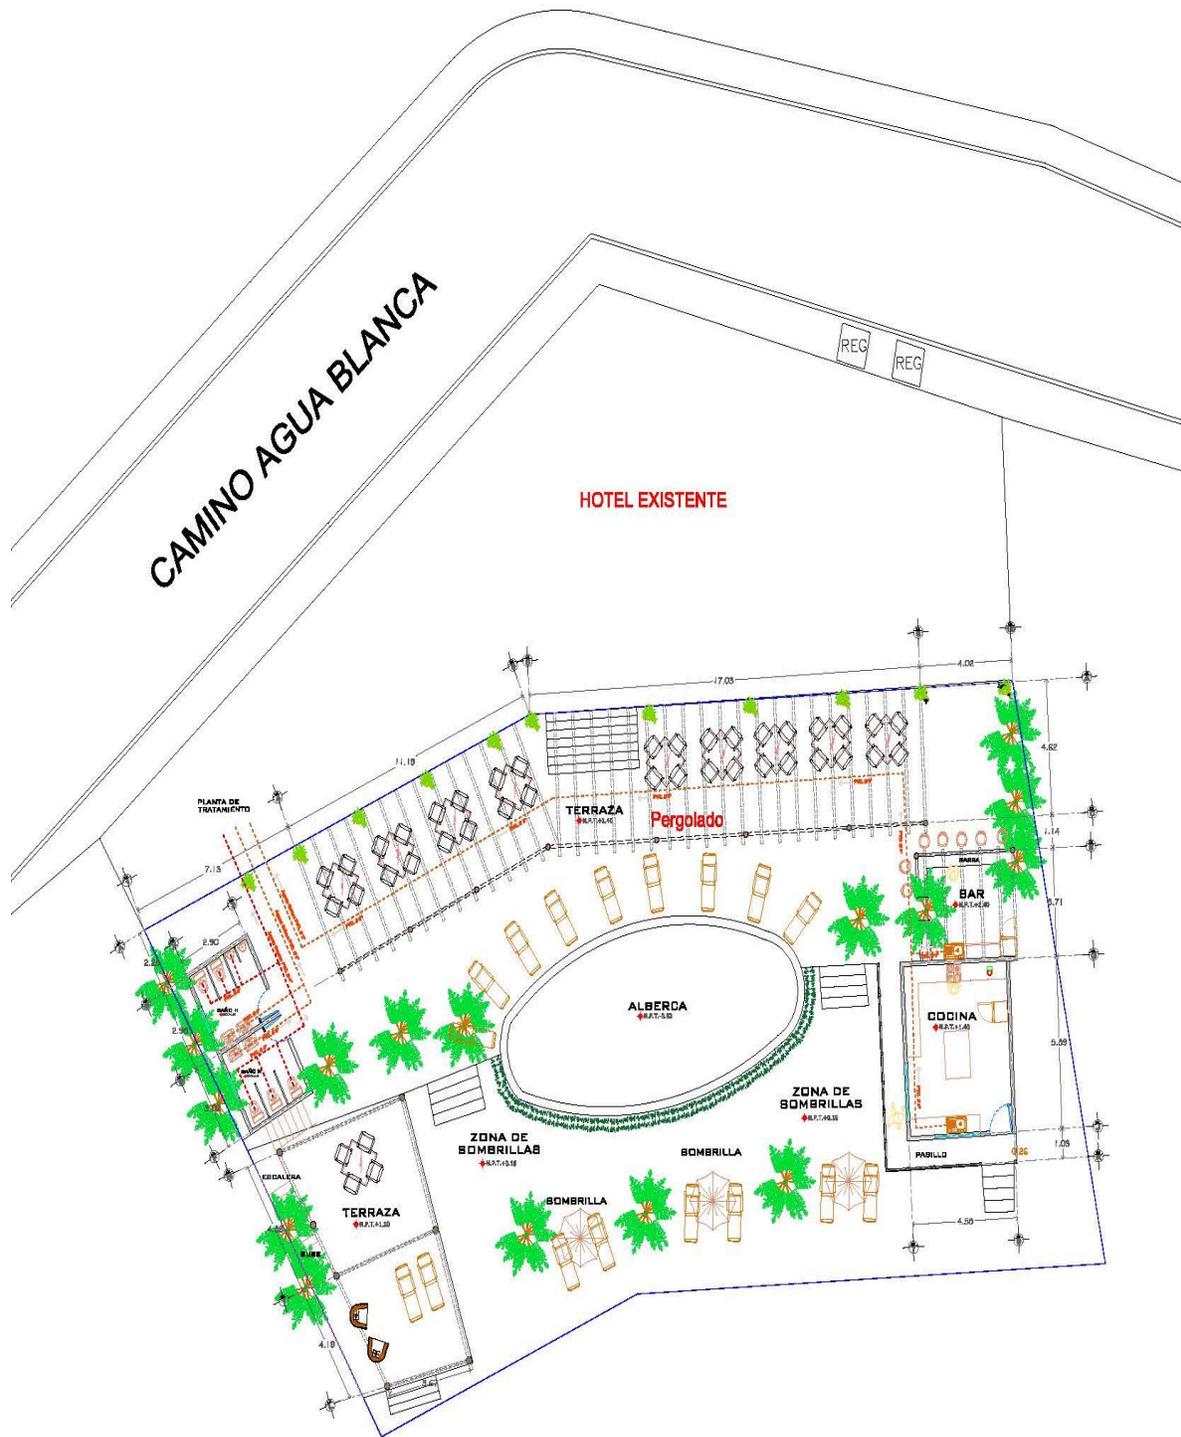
Plano arquitectónico de las obras a construir, planta baja.
